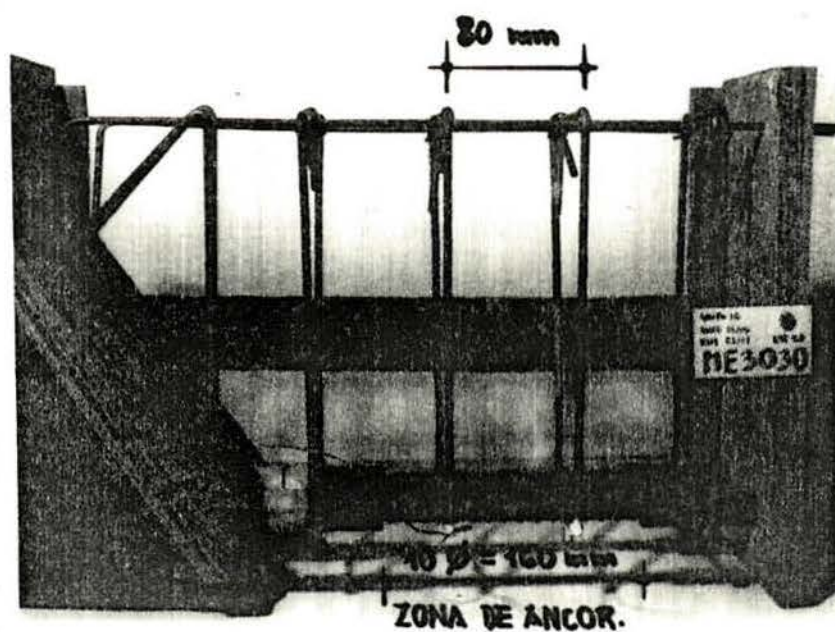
Detalhe do comprimento de ancoragem, estribos e armadura secundária (forma em fase de montagem).
